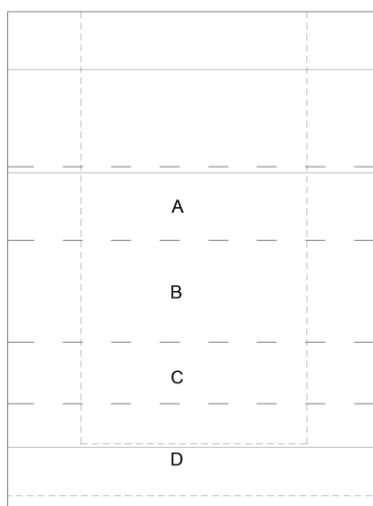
Identificação das várias secções consideradas da laje sobre o túnel hidráulico
